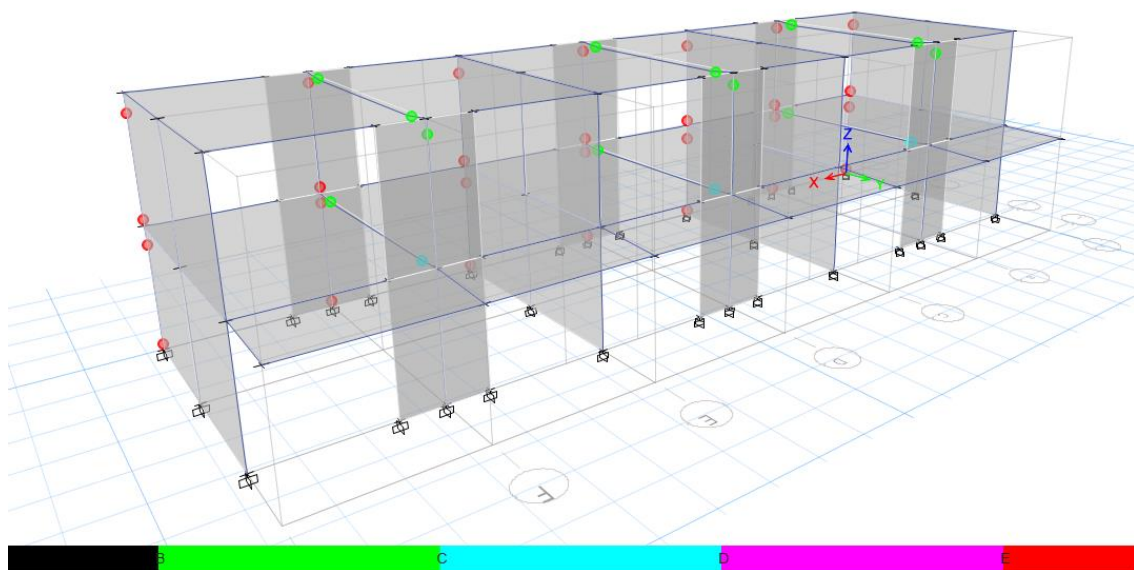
Formación de rotulas plásticas en el pabellón 4.
